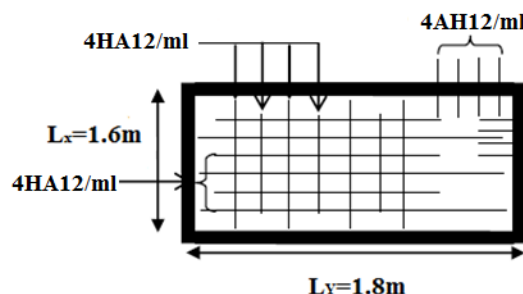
Schéma de ferrailage de la dalle de la locale machinerie.
